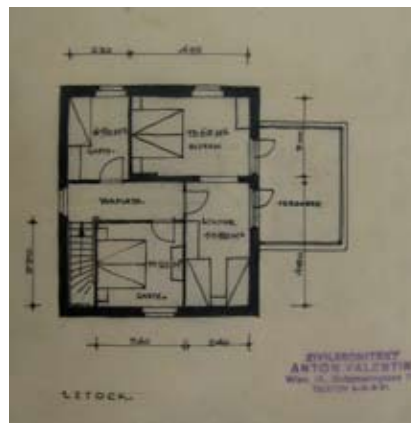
Plan 24.42: Anton Valentin. Ohne Titel. Grundriss 1. Stock. Ohne Datierung.
